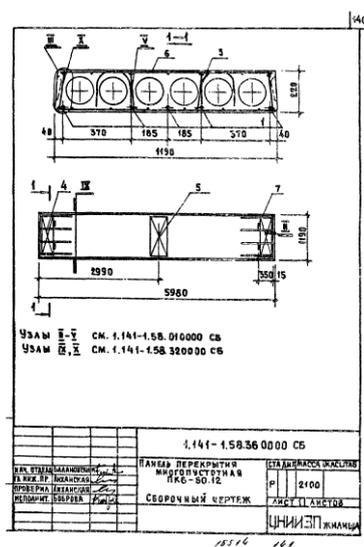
Сборная плита перекрытия ПК6-60.12 из Серии 1.141-1, вып. 58
